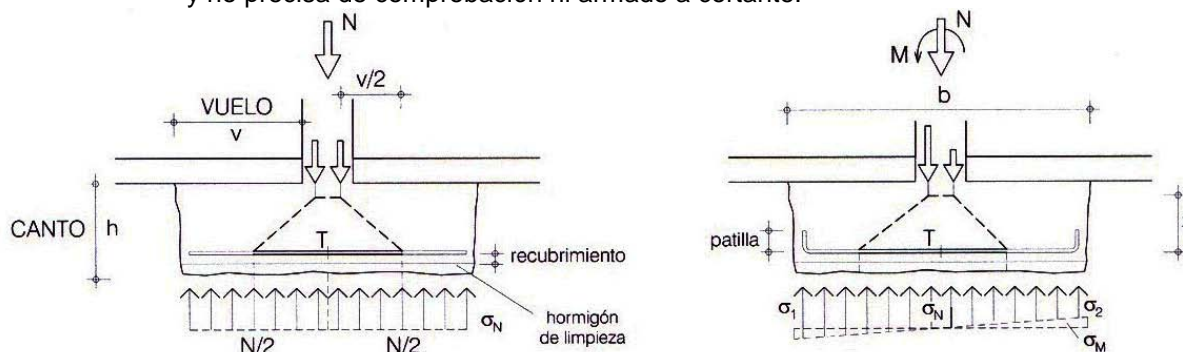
Modelo de cálculo de la armadura, (según EHE)
